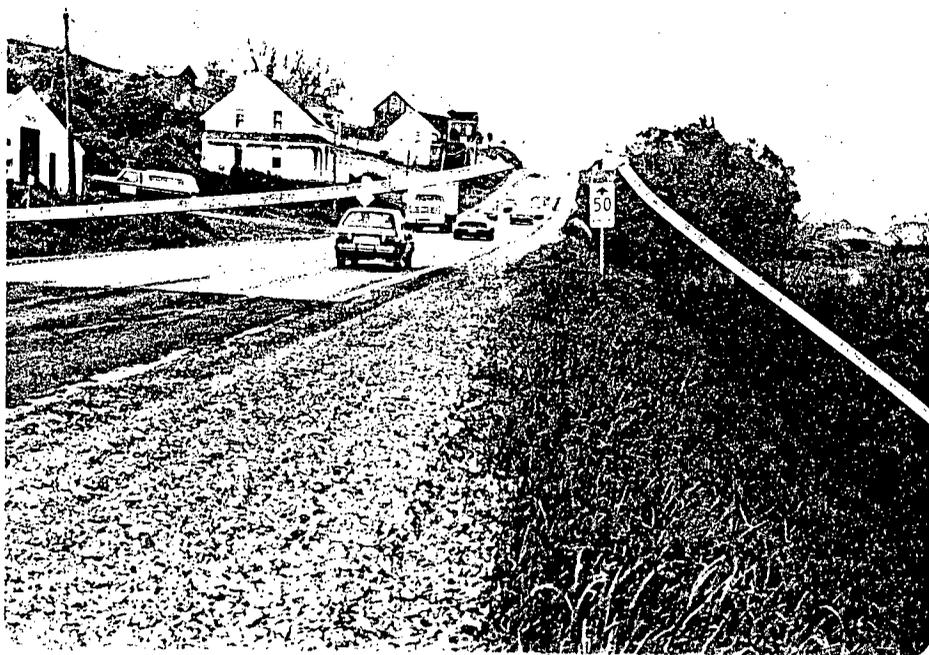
Route 173, vers Saint-Georges. A droite, la zone où seraient installés les murs de protection des berges.
